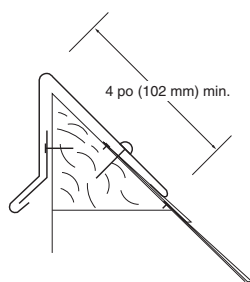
Couronnement du solin sur une arête à un seul plan incliné.
